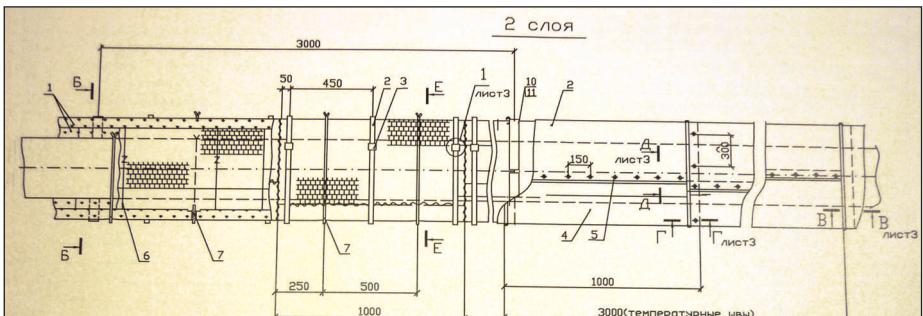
Тепловая изоляция трубопроводов матами минераловатными прошивными в обкладках в два слоя
